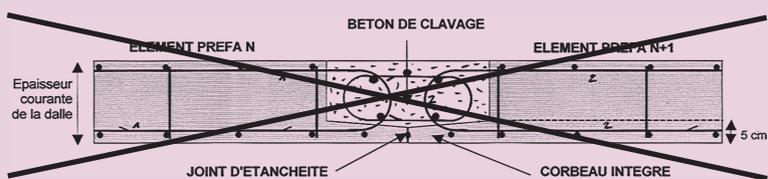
Clavage par corbeaux en béton intégrés dans l'épaisseur
